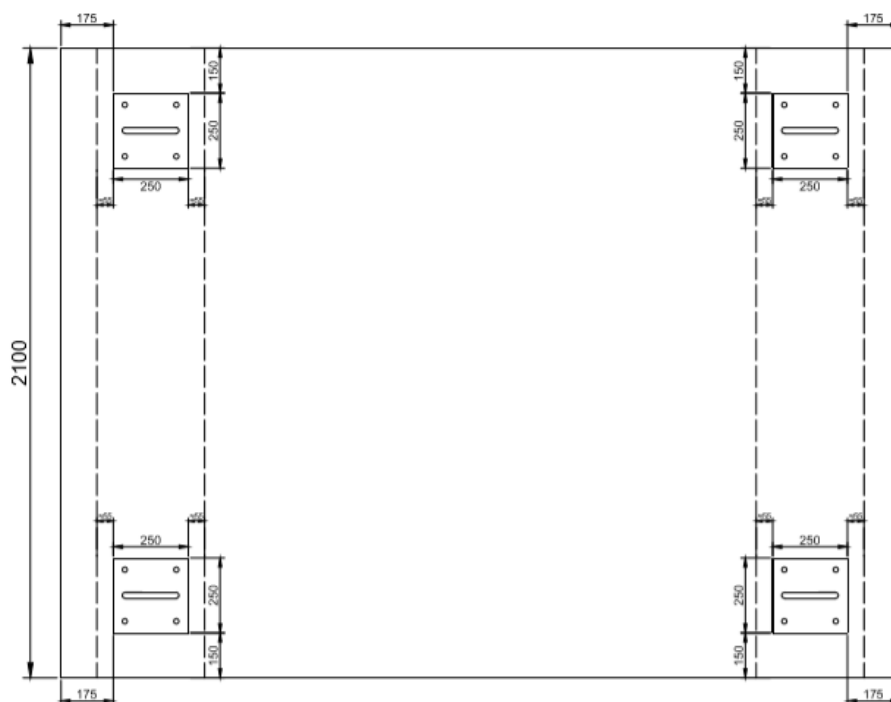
Detalle en planta de ubicación de barras de anclaje, chapa y argolla.
